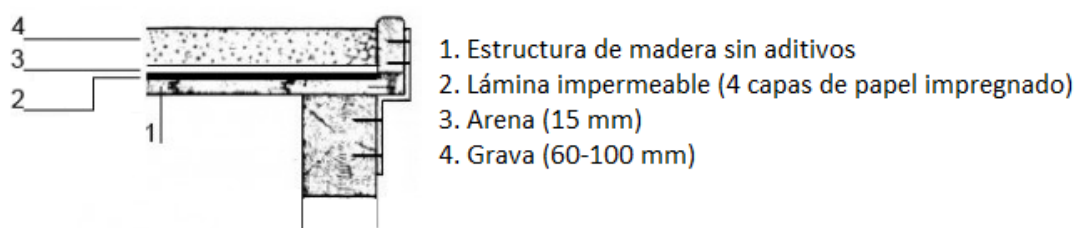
Detalle constructivo cubierta Holzzementdach.
